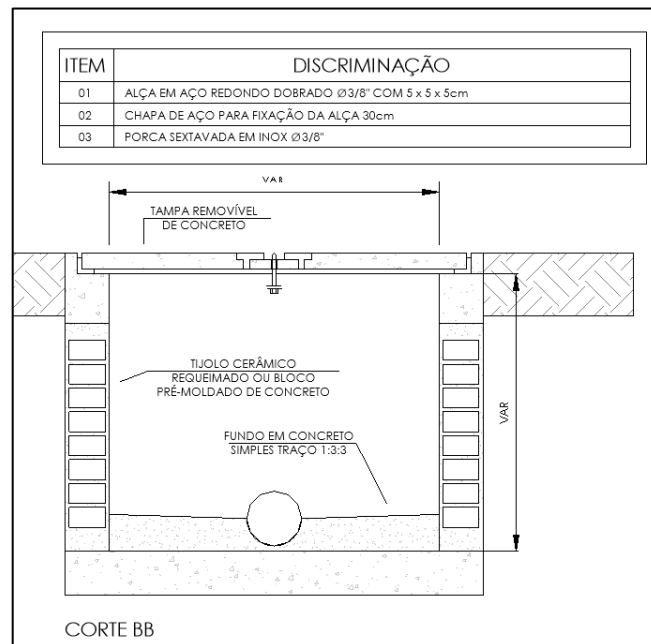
Detalhe caixa de areia com tampa de concreto
